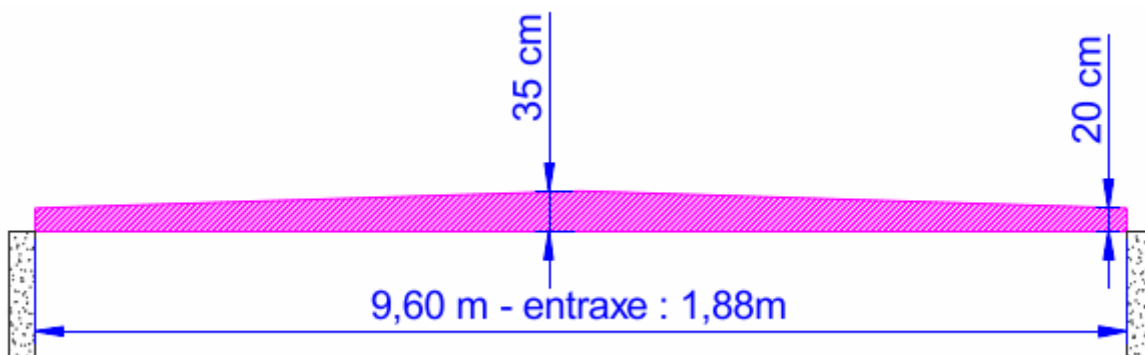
élévation sur les dimensions de l'ossature primaire de charpente
